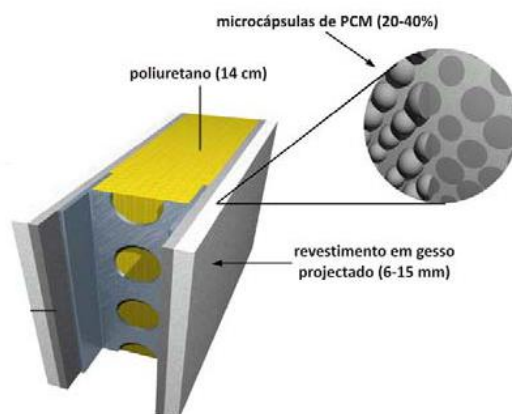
Vista esquemática da estrutura da parede [24]
